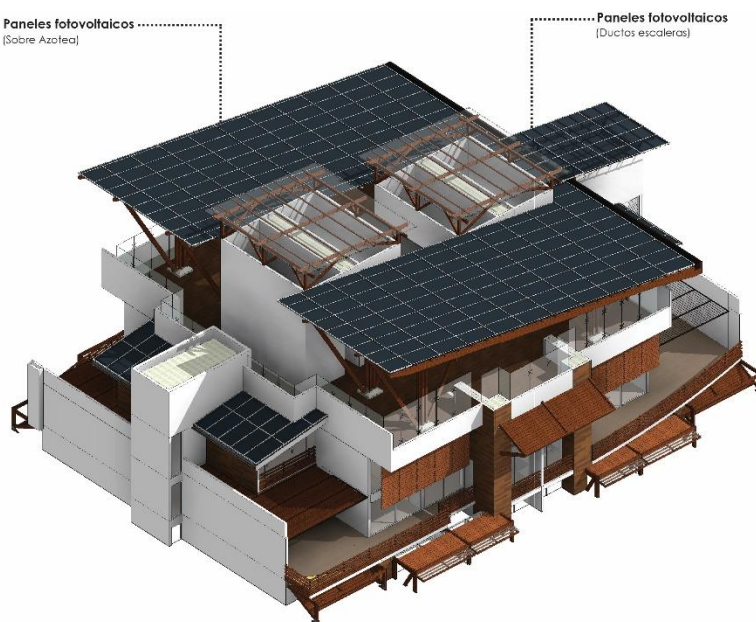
Detalle propuesta ubicación de paneles solares sobre azotea. Fuente Elaboración propia
